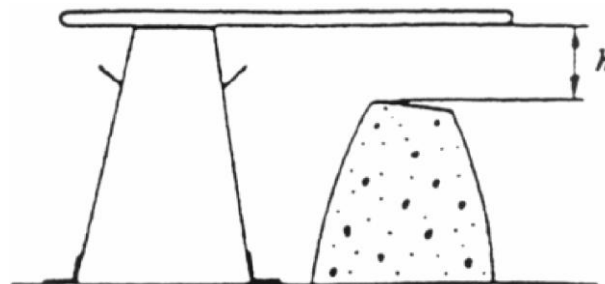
Medição da diferença de alturas (h) entre o molde e o ponto mais alto do provete após desmoldagem
